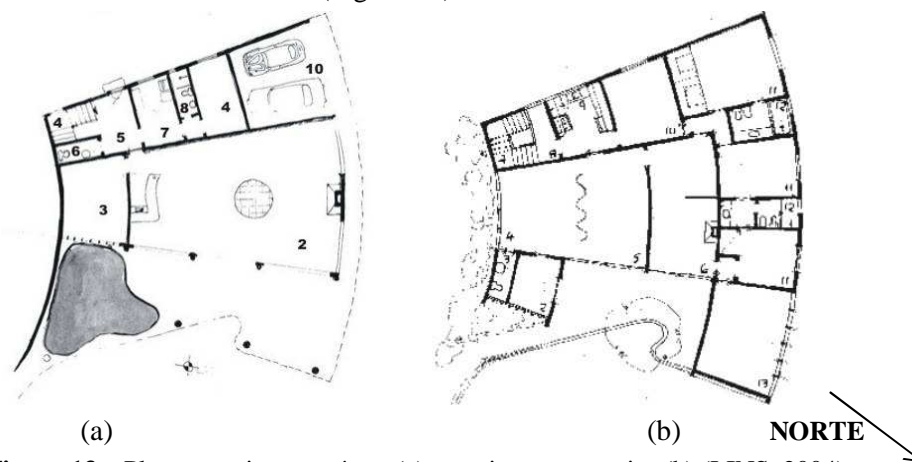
Plantas pavimento térreo (a) e pavimento superior (b) (LINS, 2004)
